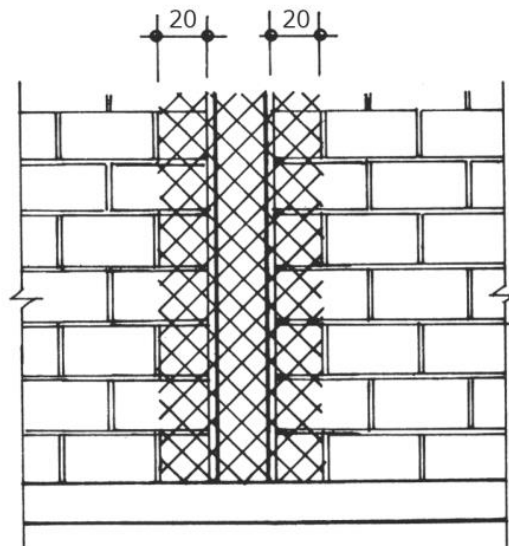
Recuperação de destacamento pilar/parede com tela metálica
